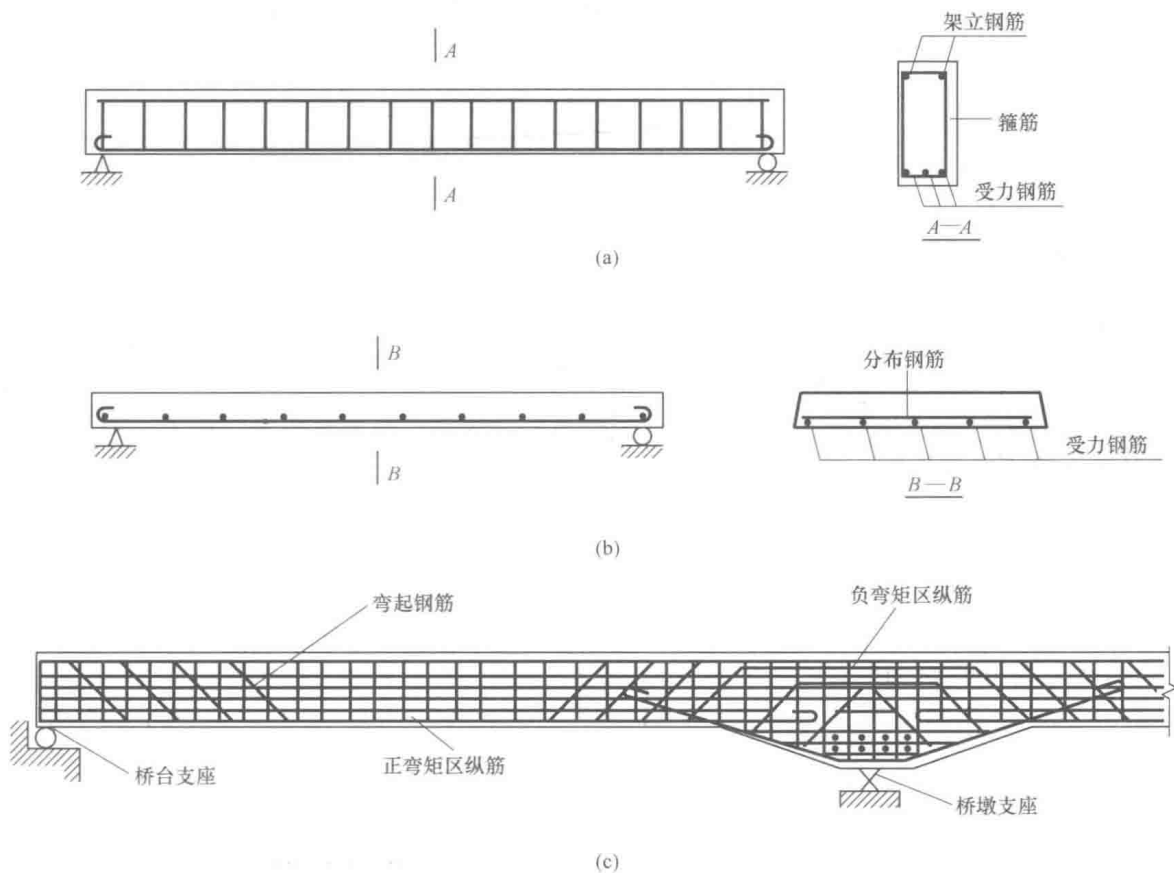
常见钢筋混凝土结构和构件配筋实例（一）
